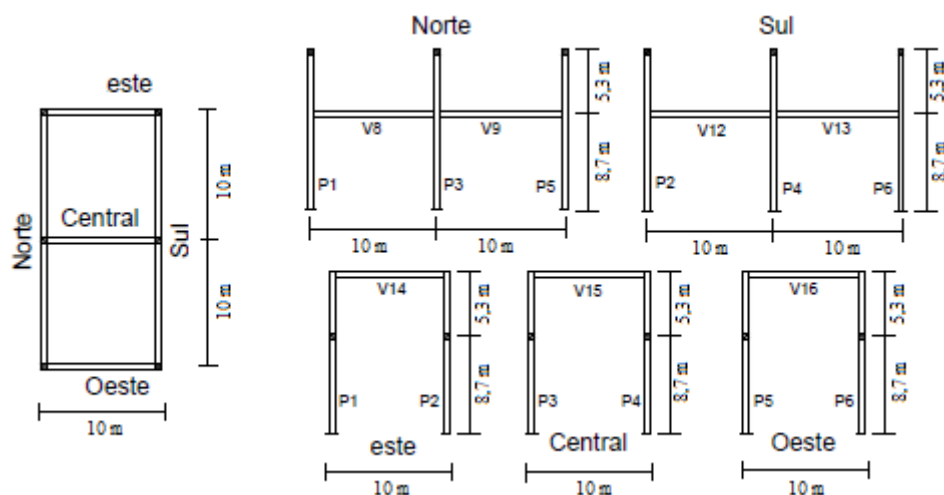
Planta e alçados dos pórticos para as estruturas metálicas
